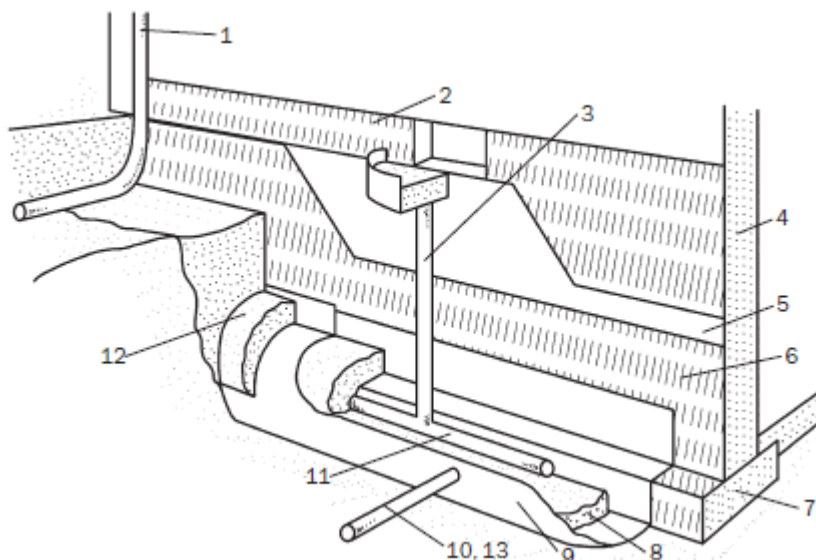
Схема наружного отведения воды от подвала: 1 – сливная труба водосточного желоба; 2 – водоприемник; 3 – стояк; 4 – стена подвала; 5 – слой гидроизоляции; 6 – защитная плита; 7 – подошва фундамента; 8 – слой гравия; 9 – геотекстиль; 10, 13 – отводная труба; 11 – дренажная труба; 12 – слой песка
